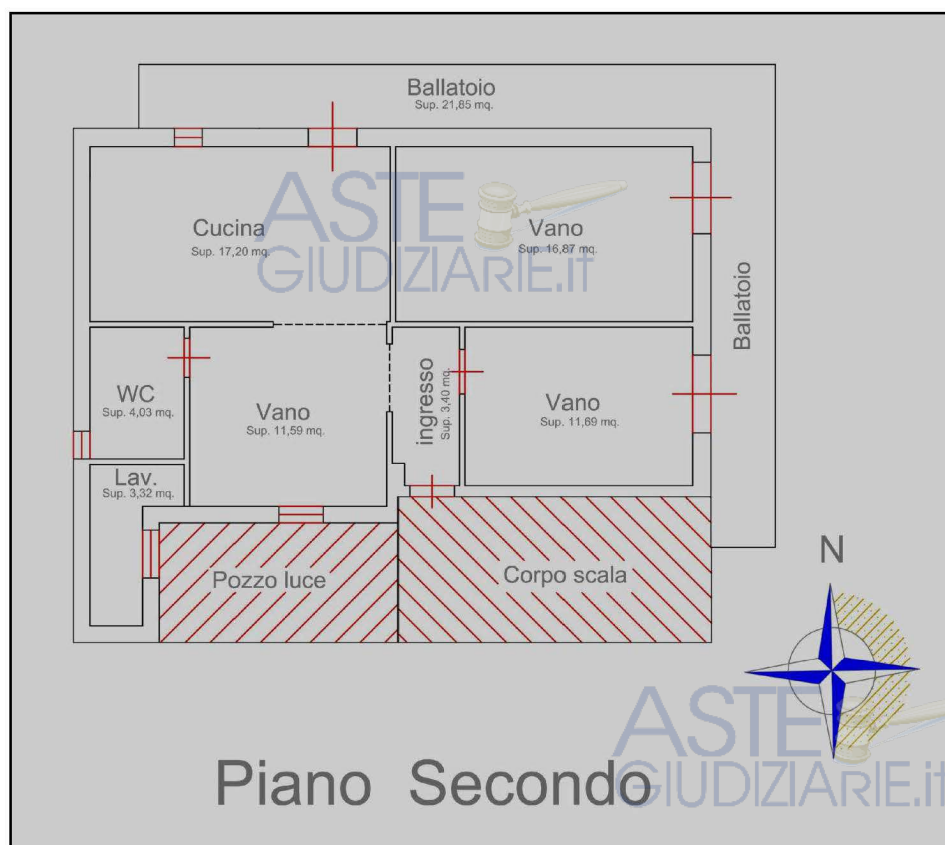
Visualizzazione della planimetria dell'appartamento con indicazione delle superfici utili interne
